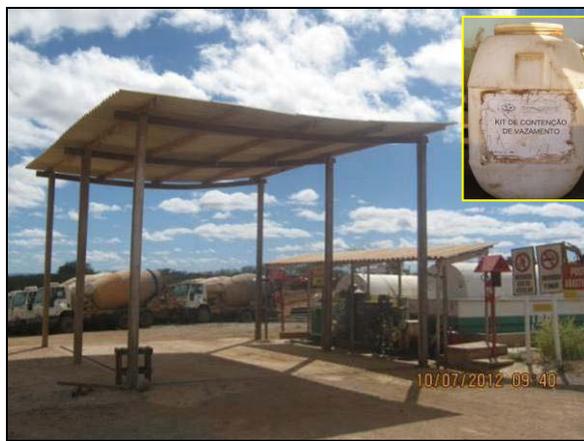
Posto de abastecimento coberto, com piso impermeabilizado, canaletas e disponibilização de kit mitigação (jul/2012).
